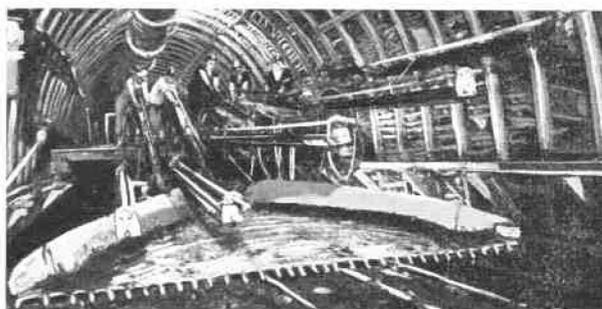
Chargeuse Duck-bill équipée de plusieurs foreuses roto-percutantes.
